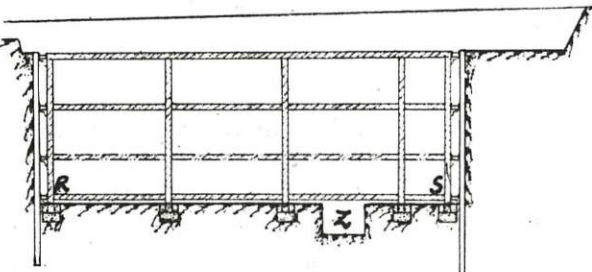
a) Enlèvement des déblais jusqu'au fond de la fouille; b) Pose du poutrage d'étaisonnement R S à enrober dans le radier; c) Déblayage en Z en sol asséché, sous la protection d'un blindage spécial.
